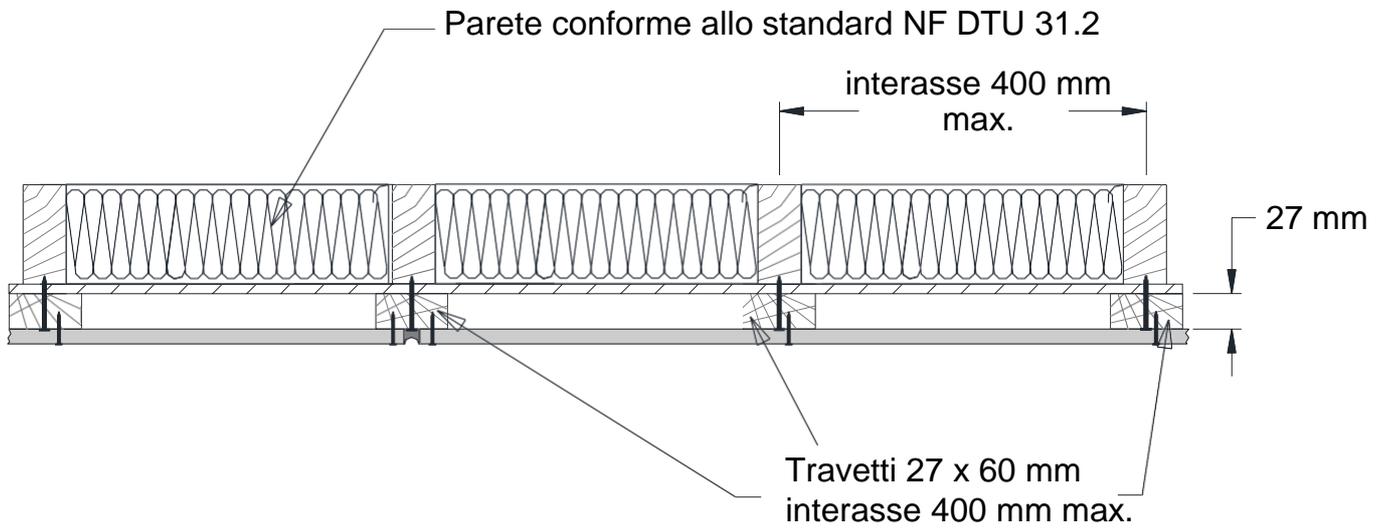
Sezione verticale su costruzione con struttura in legno - Posa orizzontale
